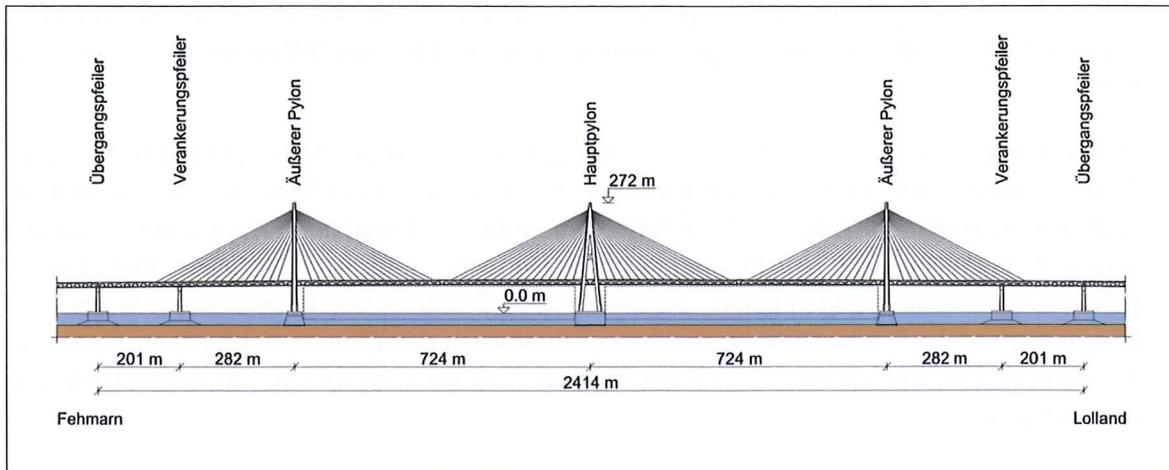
Ansicht der Schrägkabelbrücke
